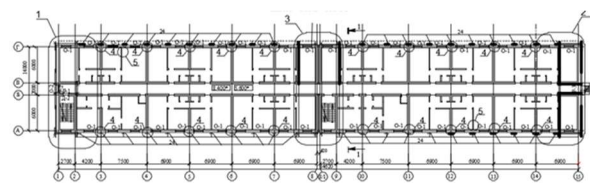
План четырехэтажного двухсекционного здания коридорного типа, построенного в 1974 г.: 1,2,3 – блоки здания, требующие усиления
